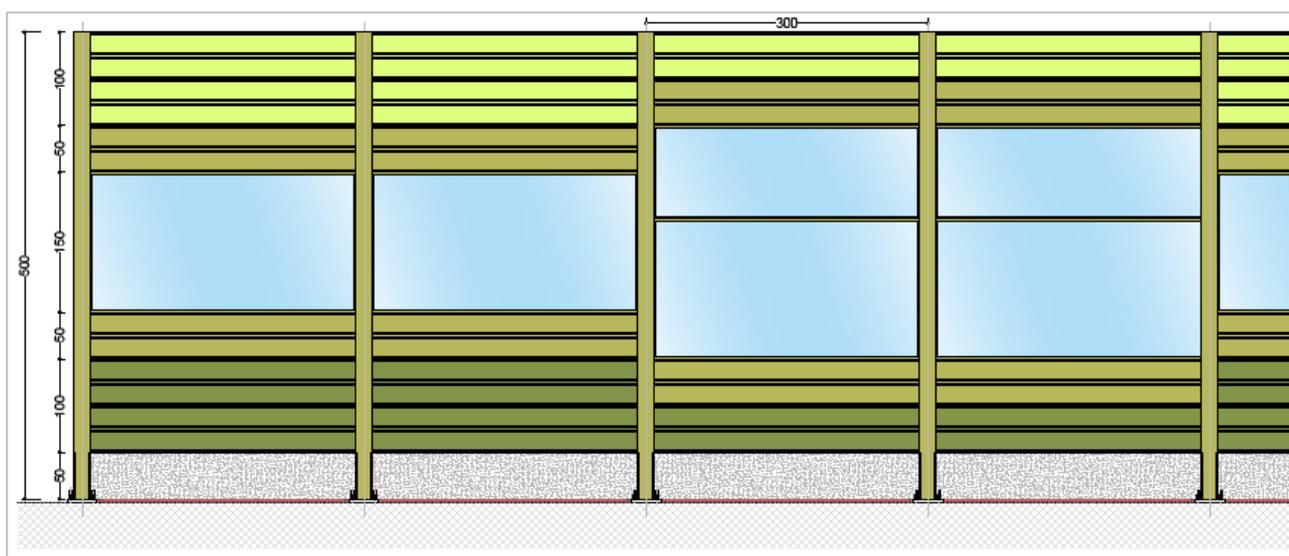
/2 Prospetto tipo Barriera n. 2 – Il prospetto illustra le finestrate previste in corrispondenza del tratto di barriera di maggiore altezza
